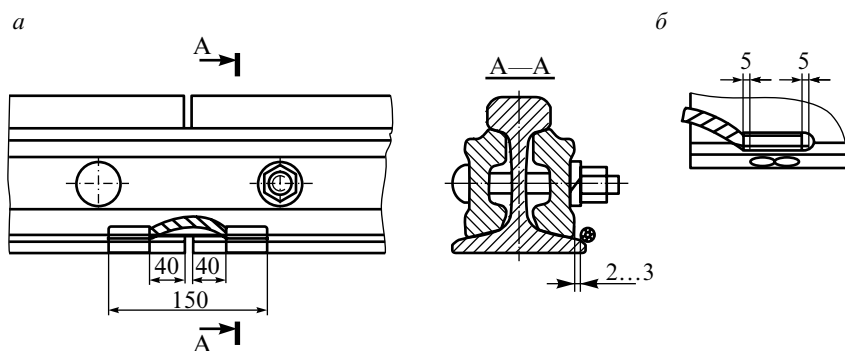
Схема установки (а) и приварки (б) соединителя к подошве объемно-закаленных рельсов типа Р65 (Р75)
